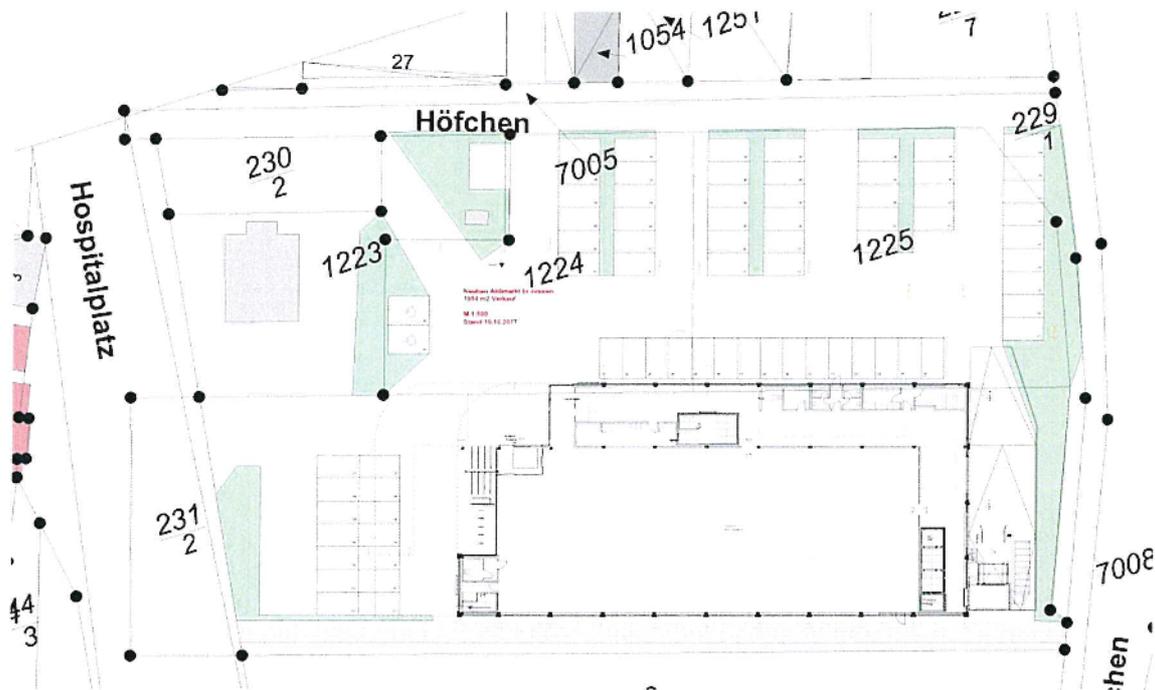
Lageplan Neubau Aldi-Markt nach Angaben des Betreibers
